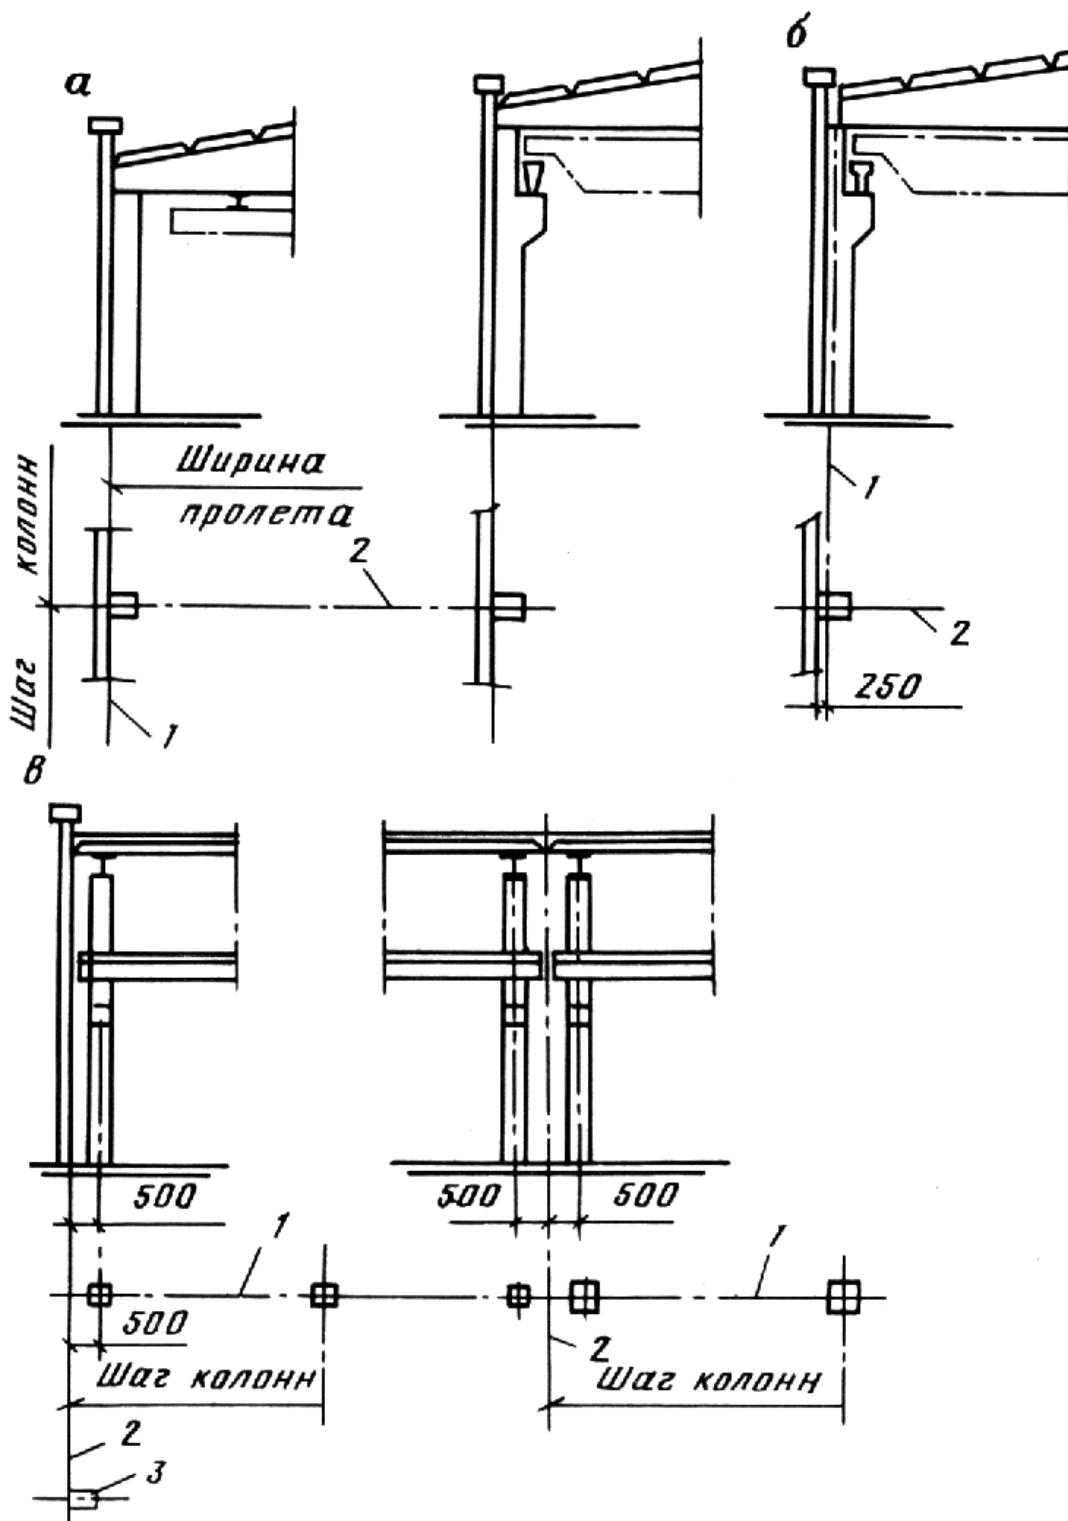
Схема привязки наружных стен и колонн одноэтажных зданий к разбивочным осям:
